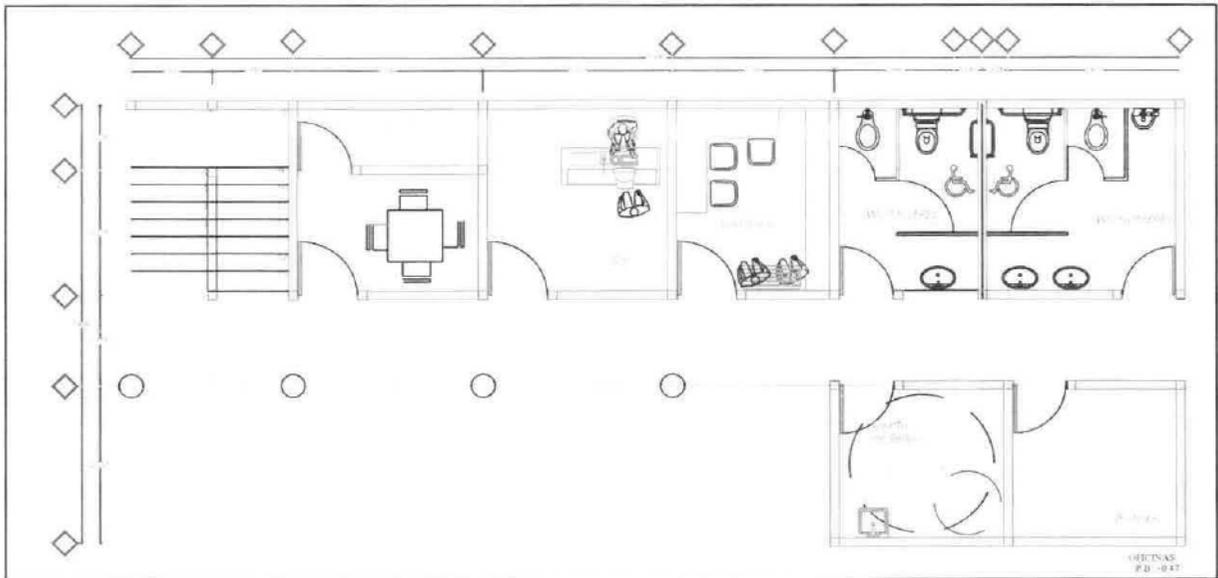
Área de Oficinas Planta Baja y Planta Alta
